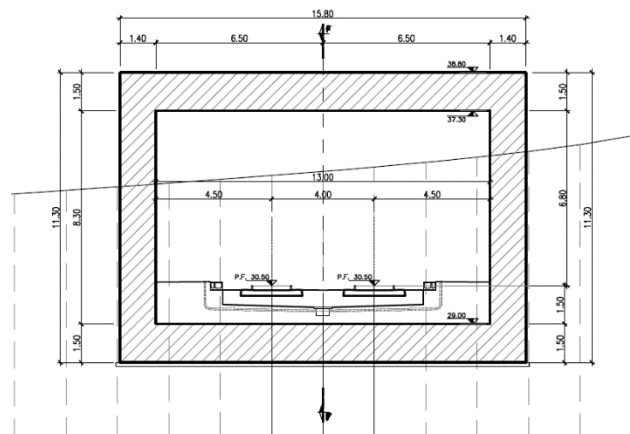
Sezione muro di imbocco ($H_{min}=6.00$ m)
